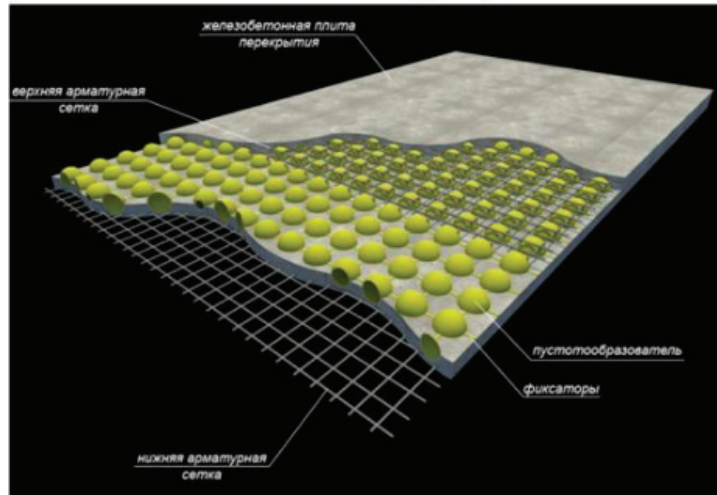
Конструктивное решение многопустотного безбалочного перекрытия
